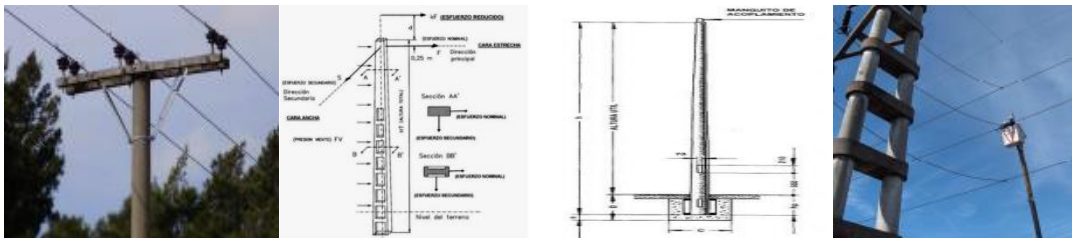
Postes de hormigón: armado, vibrado, centrifugado y pretensado [2].
